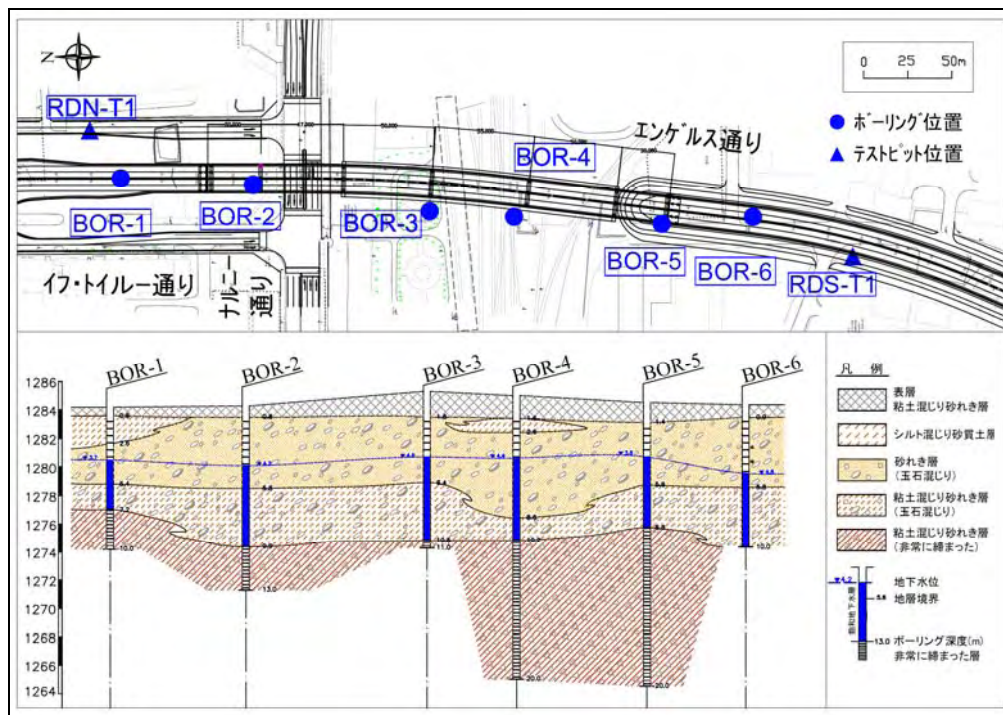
ボーリング・テストピット試験位置および地層断面図
